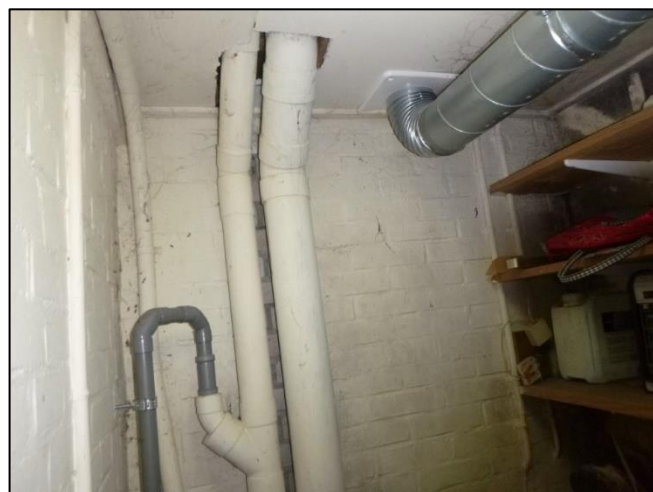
CV-ruimte: Buizen (Niet asbestverdacht)
